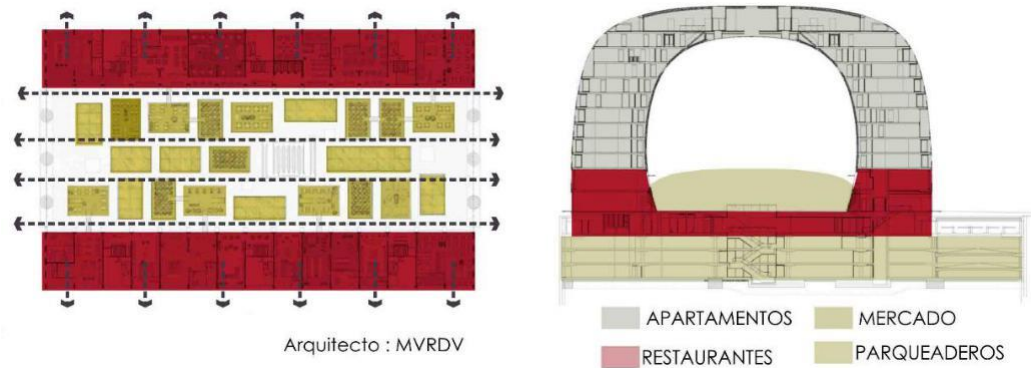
Planos Plaza Markthal Rotterdam-Holanda
